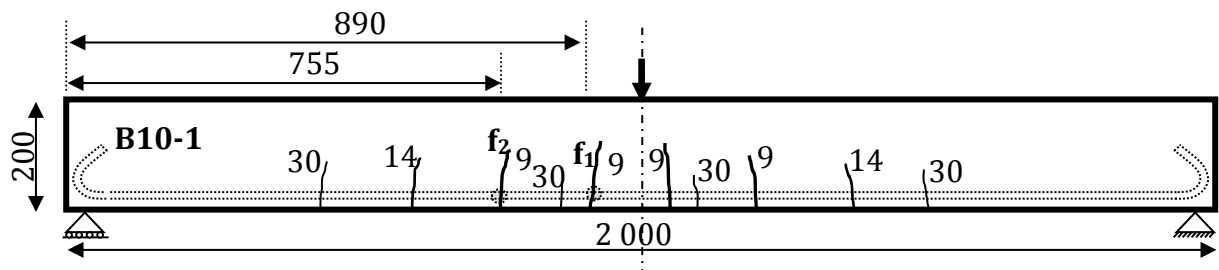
Cartes des fissurations de la poutre B10-1 au niveau de pré-chargement de 13.5 kN.m.
